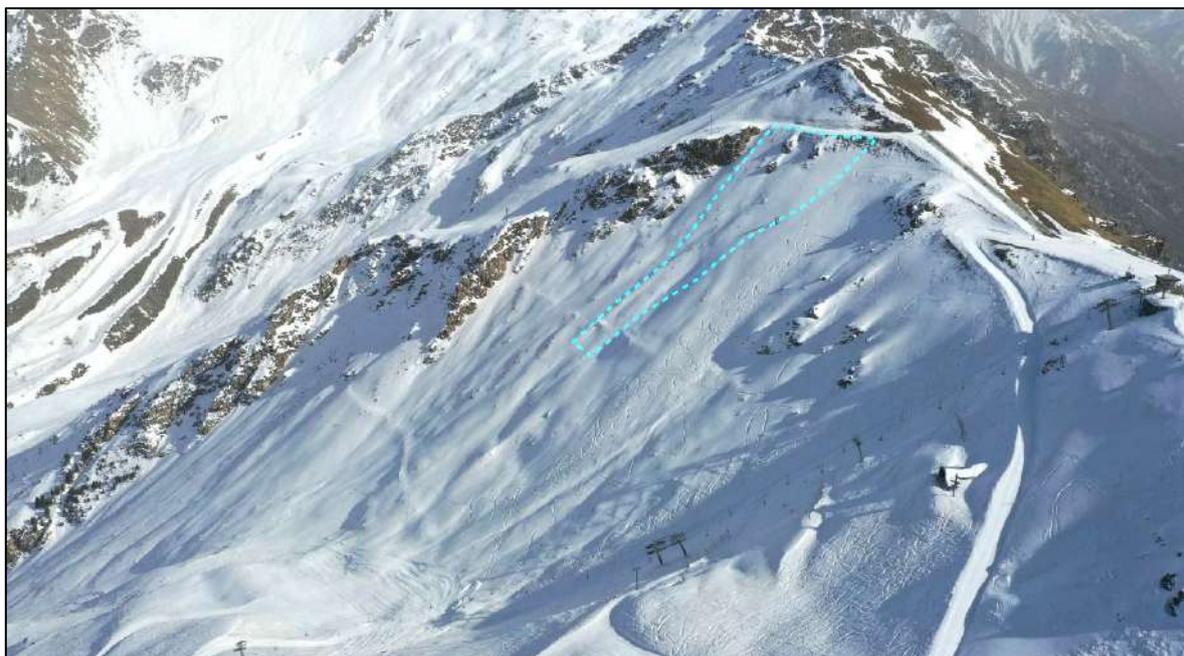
INDIVIDUAZIONE AREA IMPIANTO PARAVALANGHE
